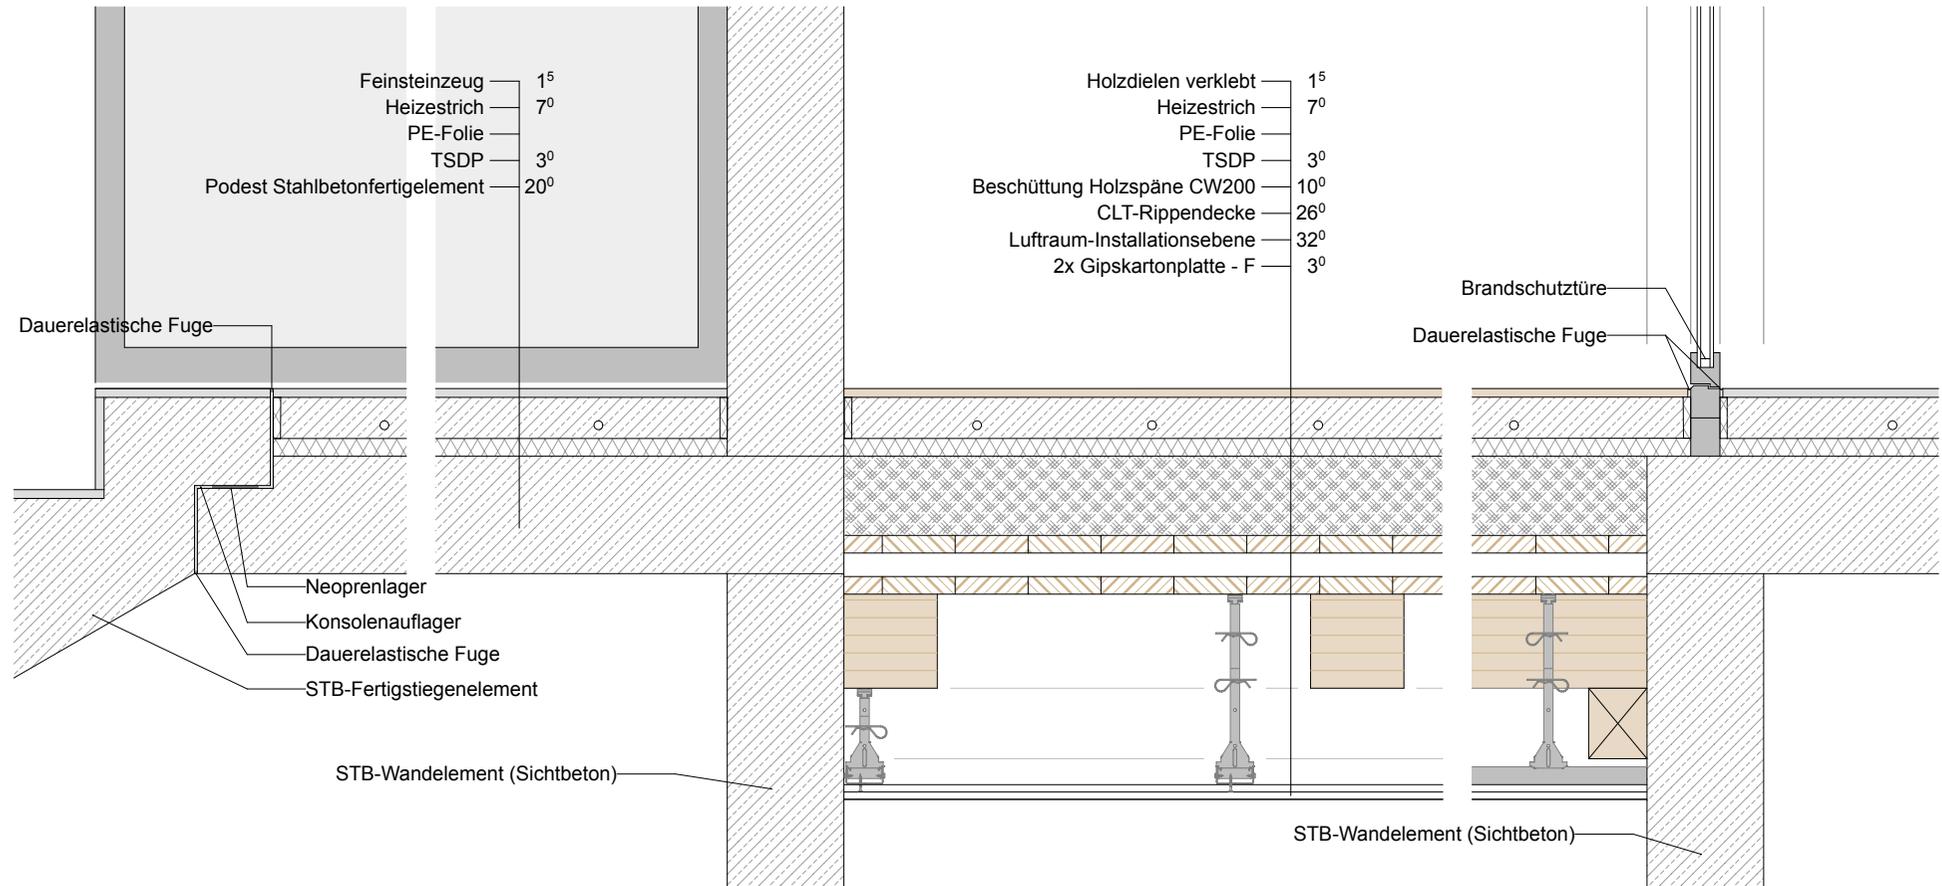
Bauteilanschlüsse Erschließung und Treppenhaus 1.OG, M 1:20
